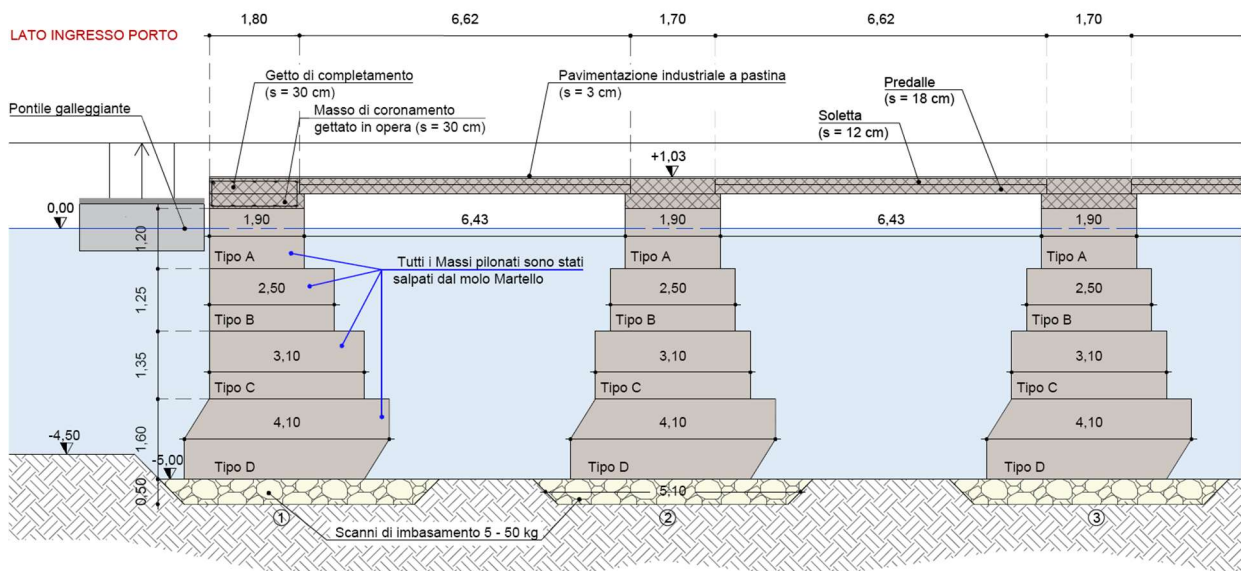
Stralcio di sezione tipo pontile fisso pescherecci
